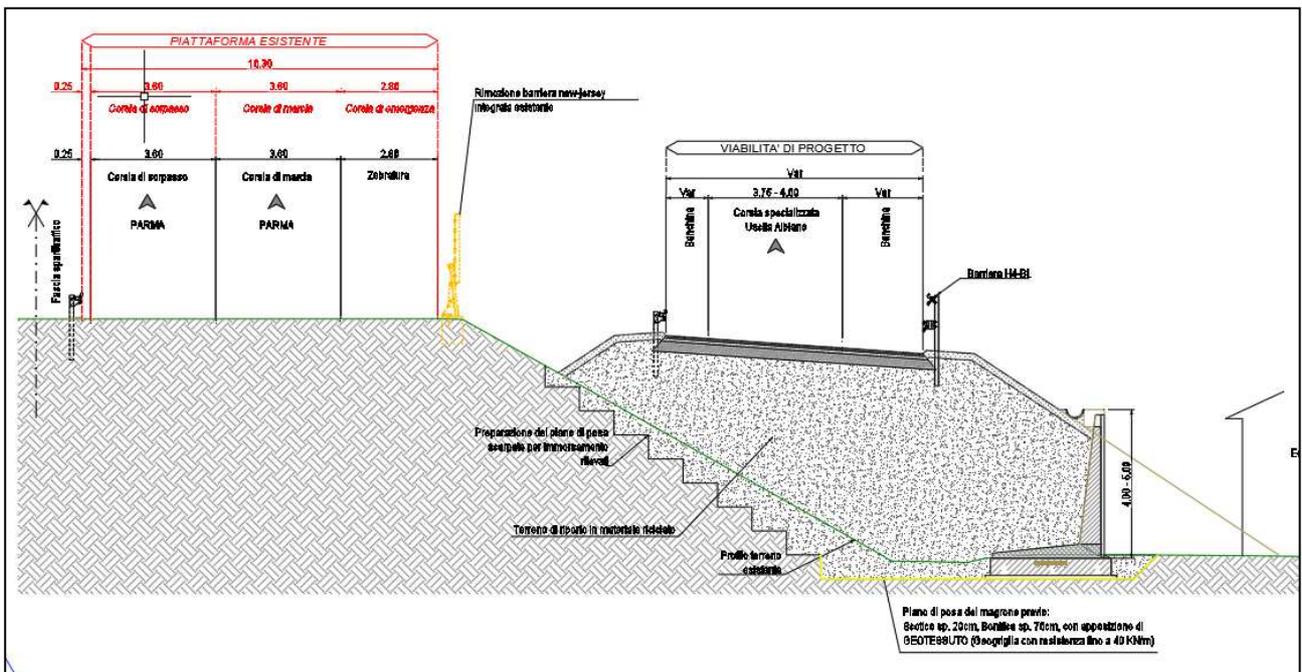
Sezione tipo rampa in uscita - muro di sostegno
